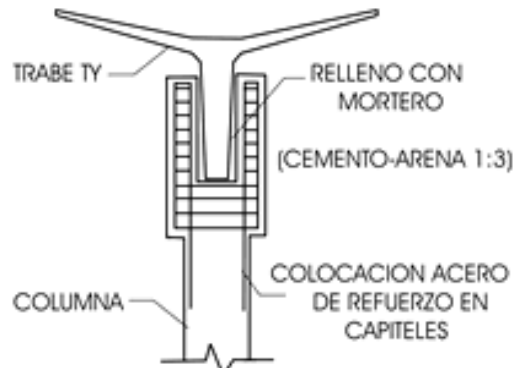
Detalle de apoyo de trabe TY. Vista frontal
